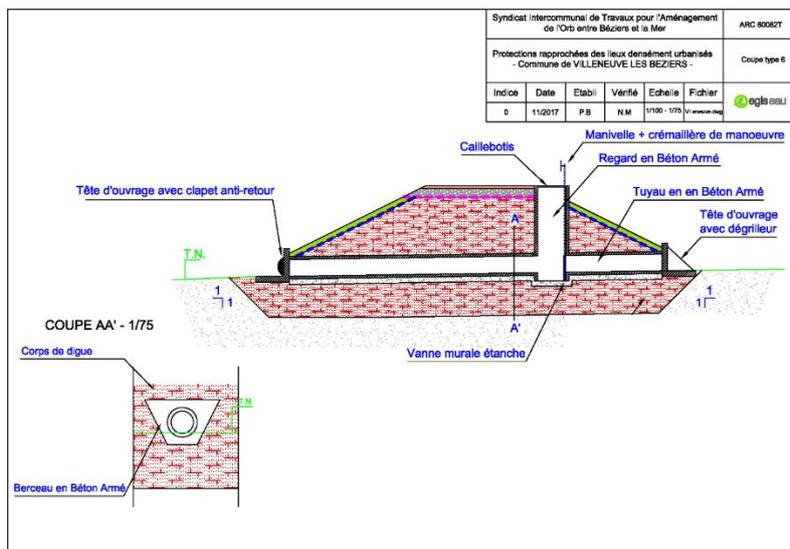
Coupe type d'un ouvrage traversant la digue (source : EGIS)
